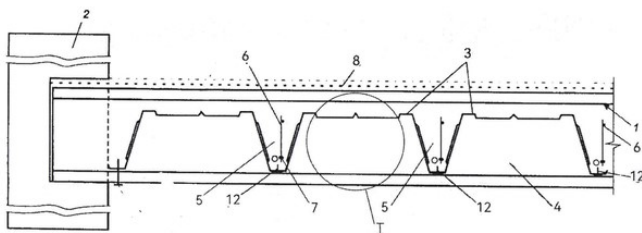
Фрагмент возводимого перекрытия с использованием несъемной опалубки, установленной на несущей опоре, опирающейся на стену (ригель, прогон) (поперечный разрез) [6], где: 1 – несущая опора; 2 – стена и/или колонна и/или прогон; 3 – опалубка;
